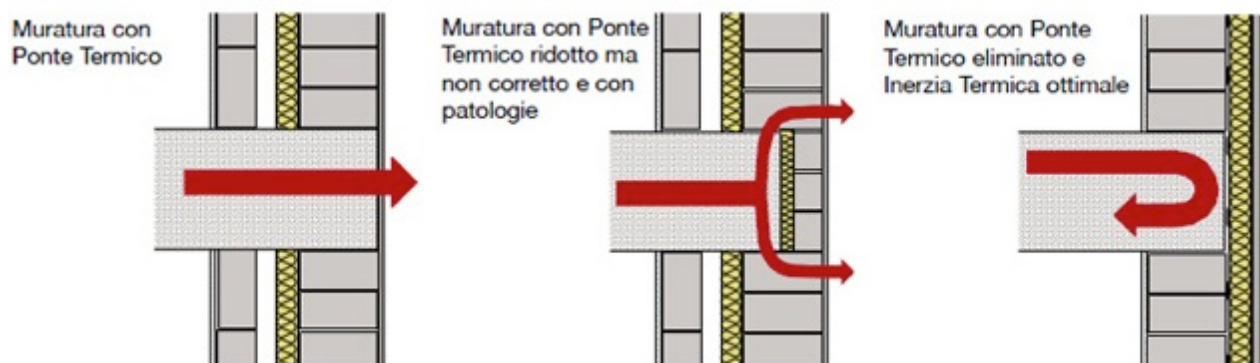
Schema di soluzione di ponte termico solaio – muratura
